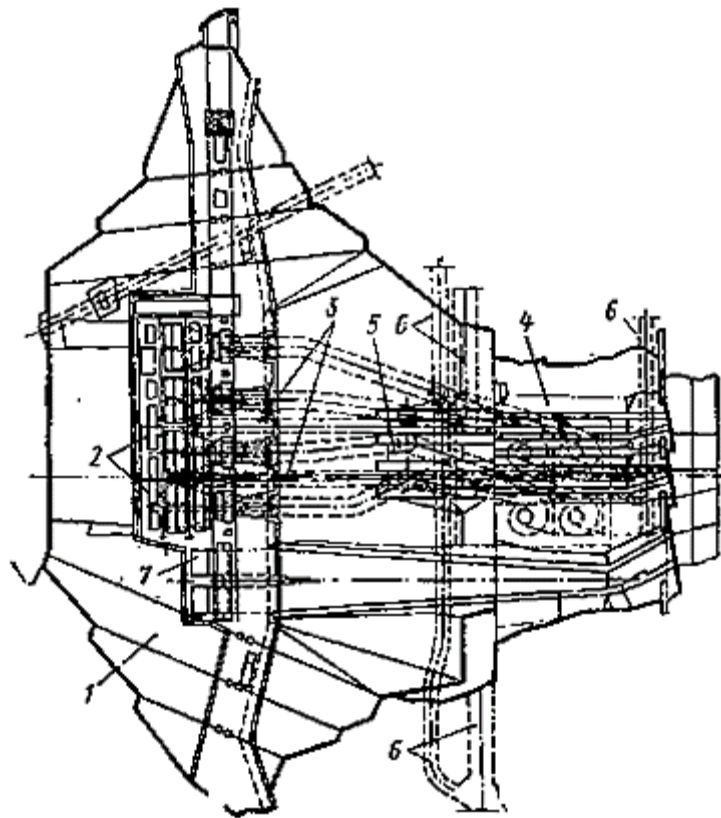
Токтогульський гідровузел на р. Нарин: 1 – гребля; 2 – водозабір ГЕС; 3 – трубопровід ГЕС; 4 – затвори водоскидів; 5 – будівля ГЕС; 6 – монтажний майданчик; 7 – межа цементациі
